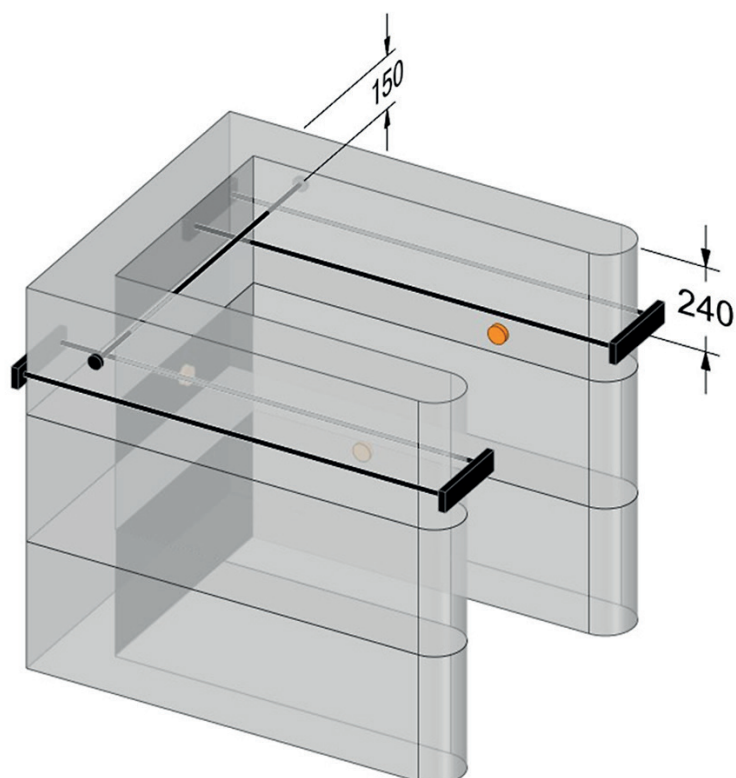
Схемы размещения (вдоль и поперек потока) предварительно напряжённой базальтокомпозитной арматуры усиления опытных моделей
